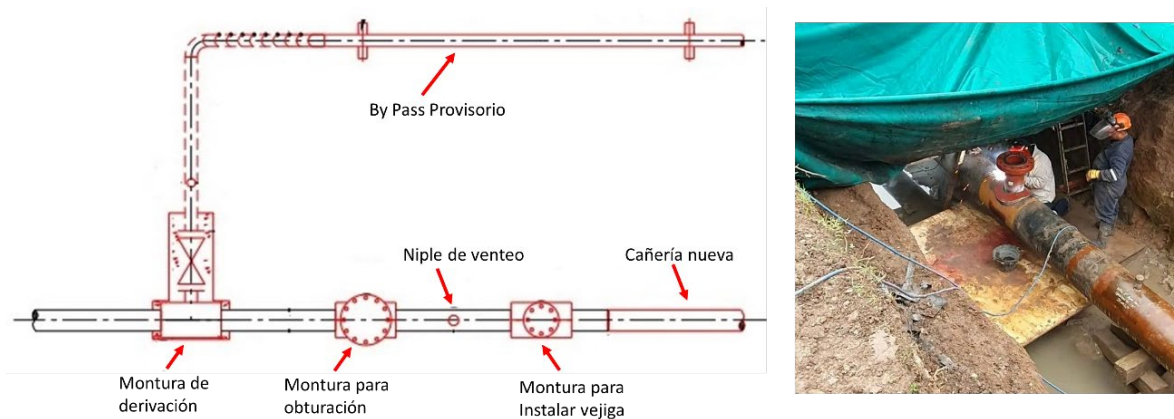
Izq. Esquema típico de reemplazo con bypass y dcha. soldadura de niple con refuerzo en gasoducto 8" para instalar vejiga.
